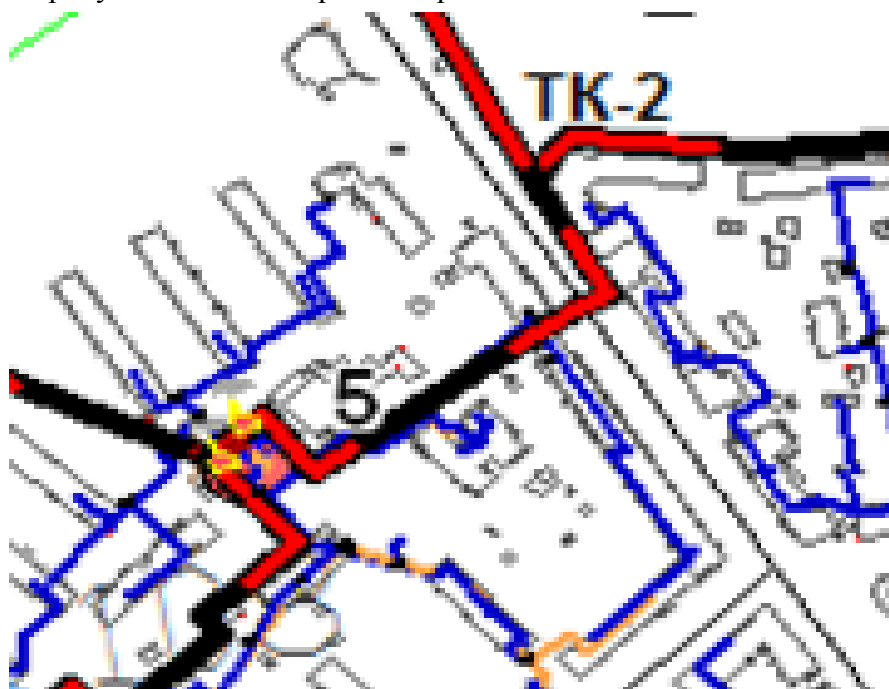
Схема прокладки трубопровода между котельными №5 и №26
